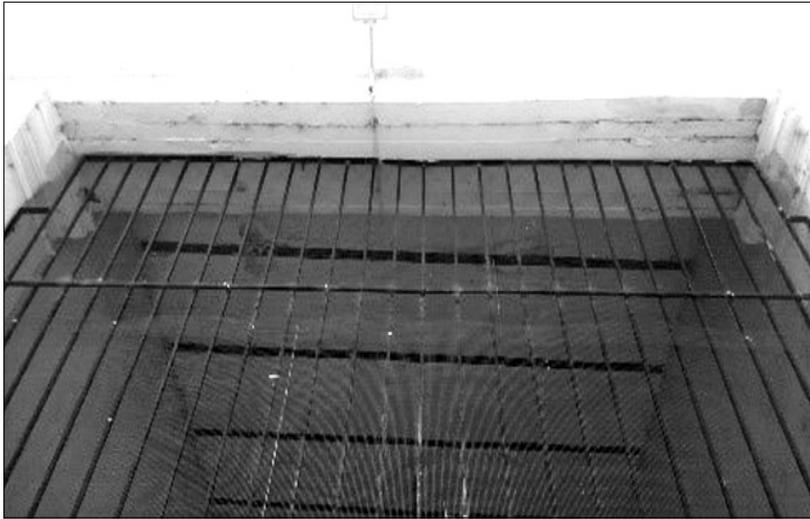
Vista de una trabe compuesta por viguetas metálicas y concreto en la casa del director de la casa-escuela de niños en el barrio de la Mejorada. Foto del autor, 2017.
